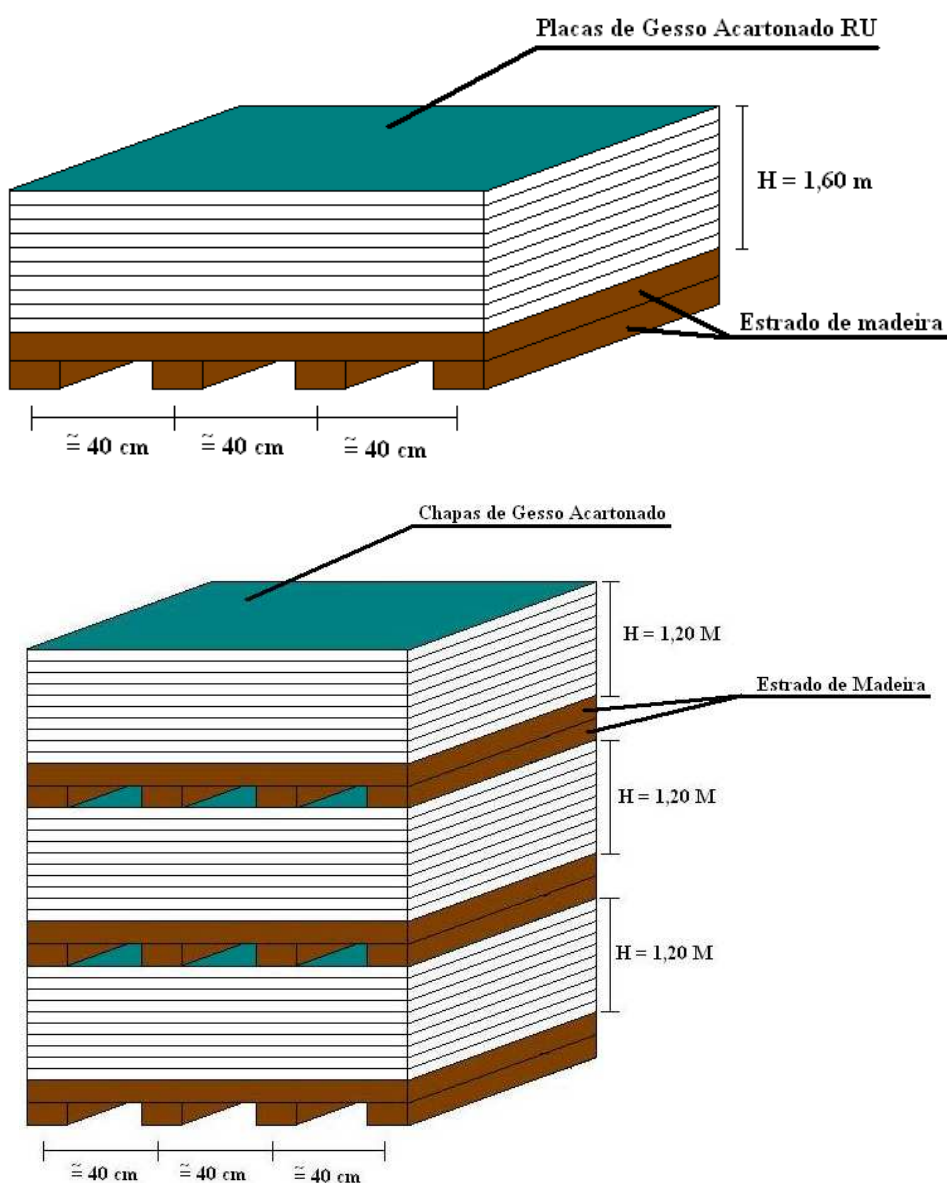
Armazenagem das chapas de gesso empilhadas (LABUTO, 2013)
